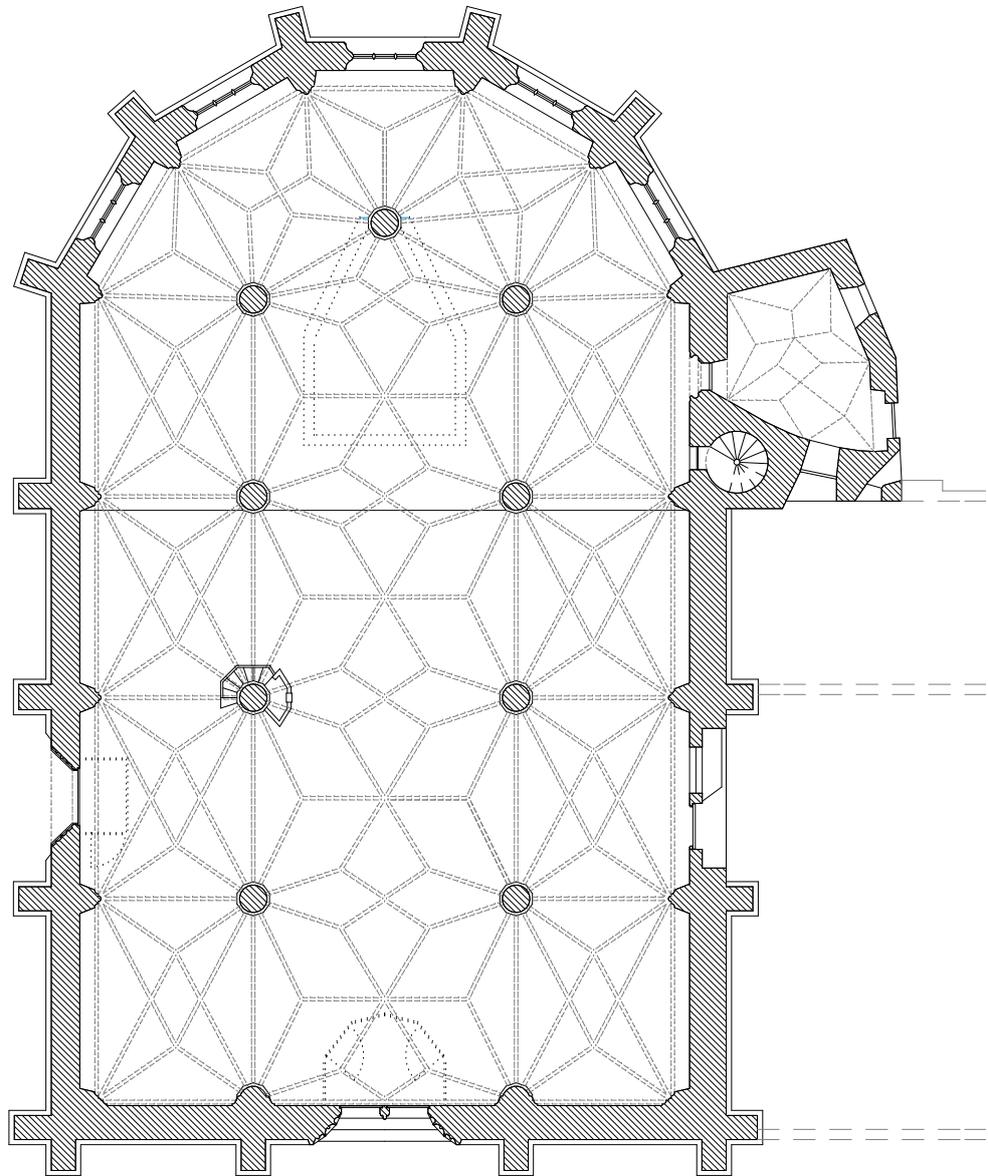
Meran, Heiliggeist. Grundriss. Bild: Verf.
